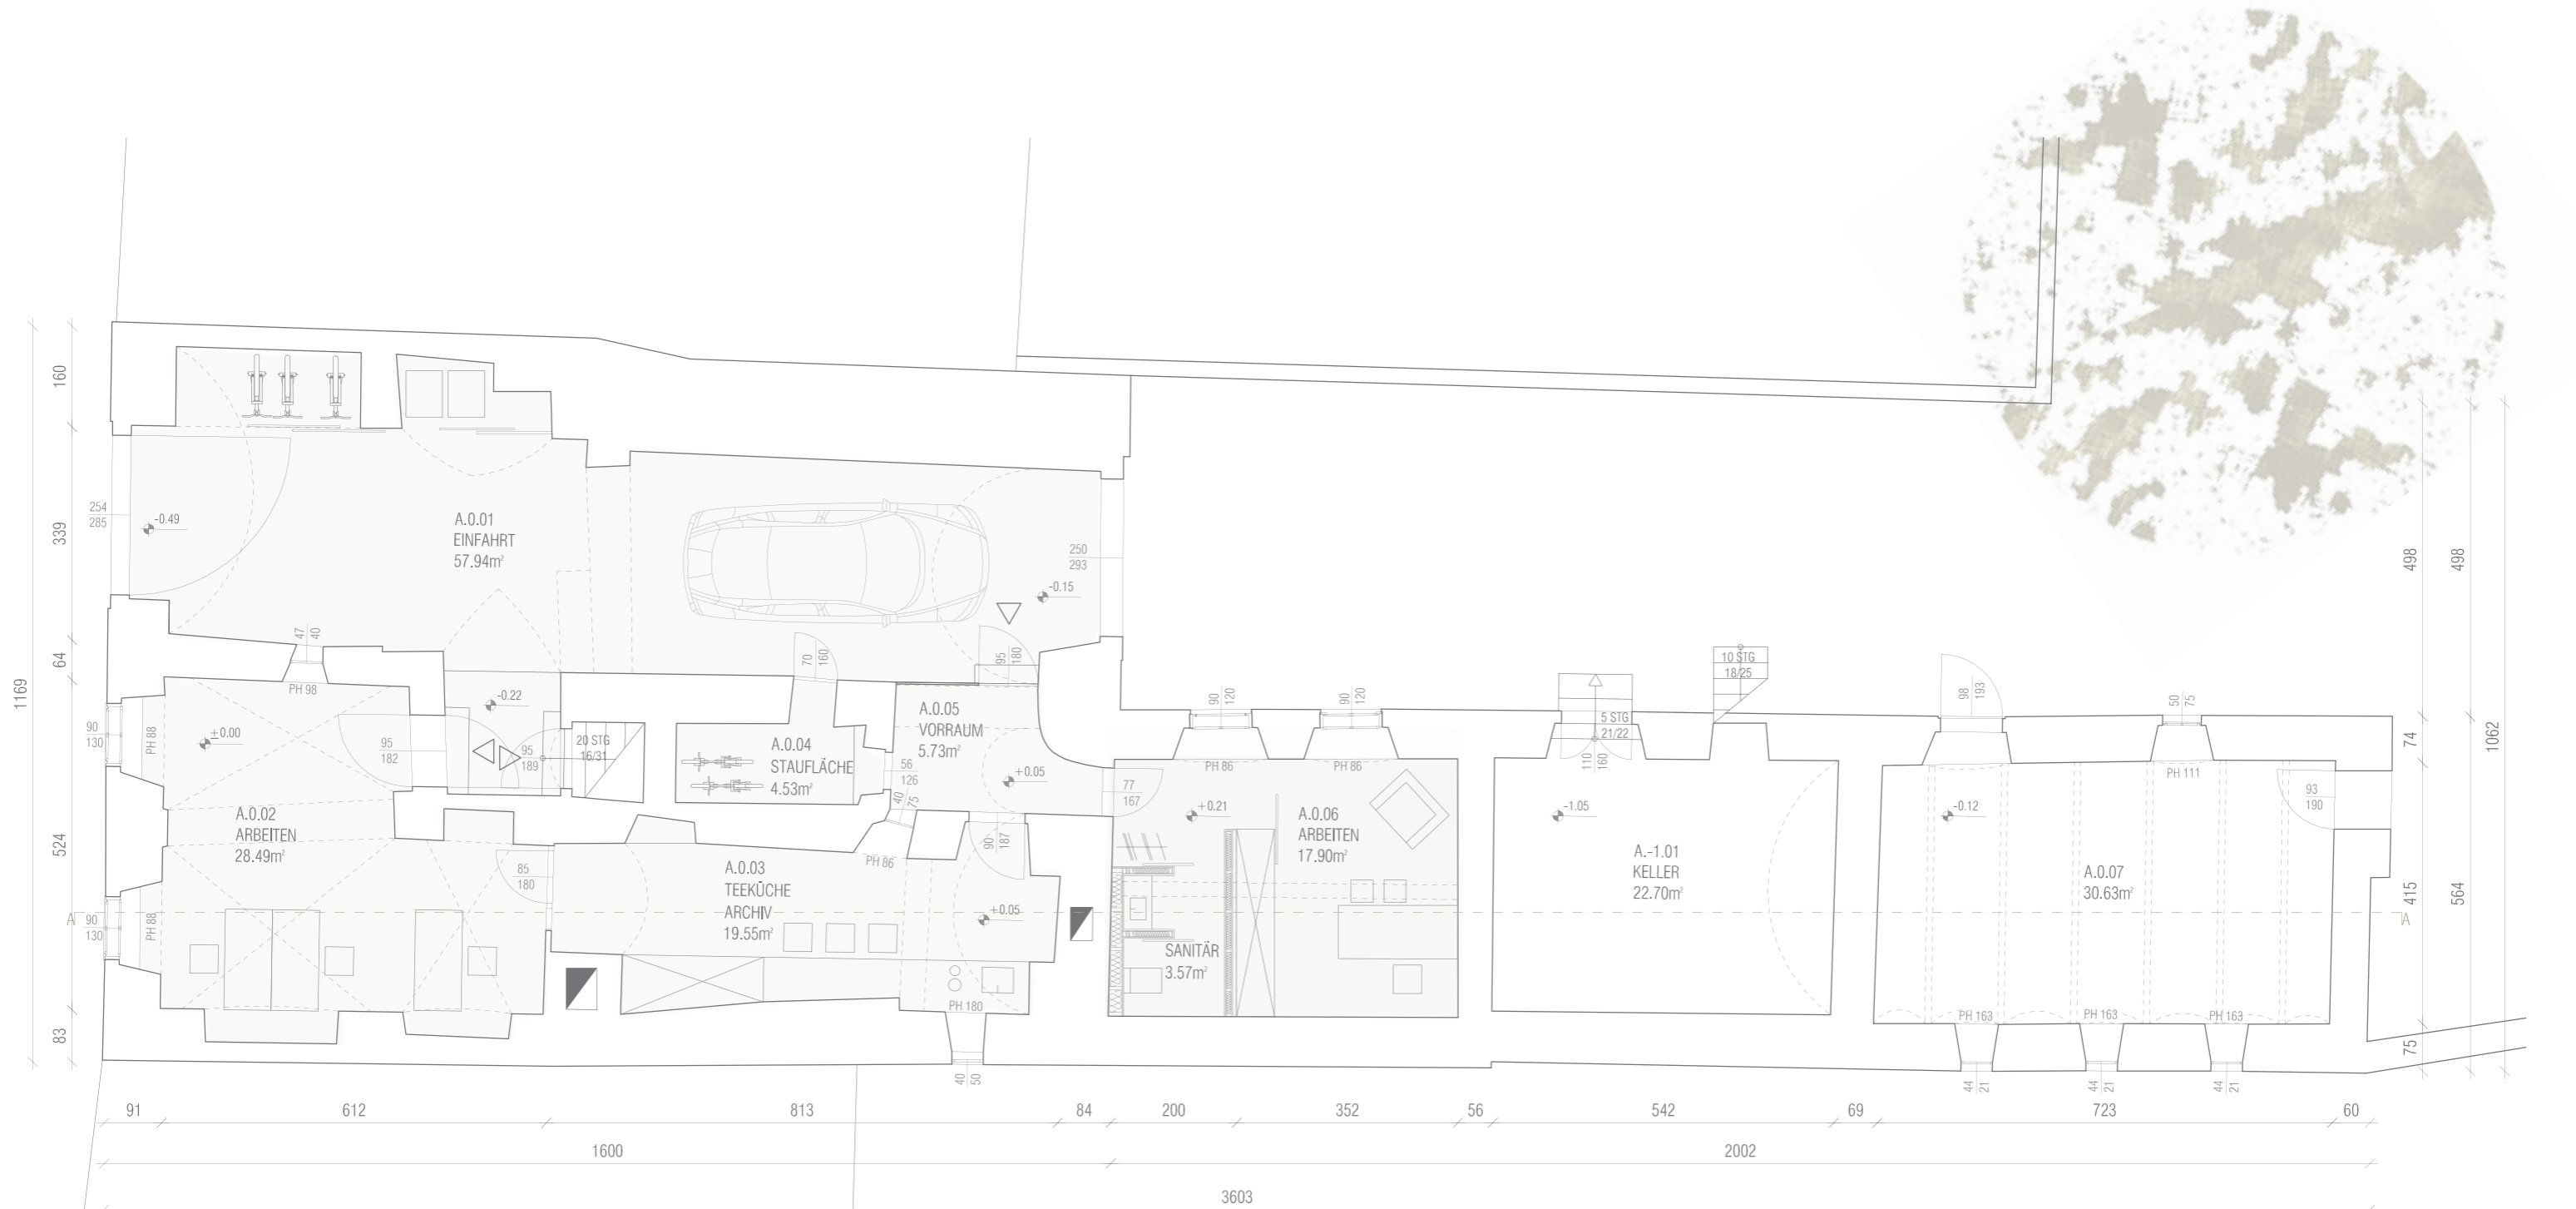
Gebäude A_STARTHAUS_Grundriss Erdgeschoss Maßstab 1:100
